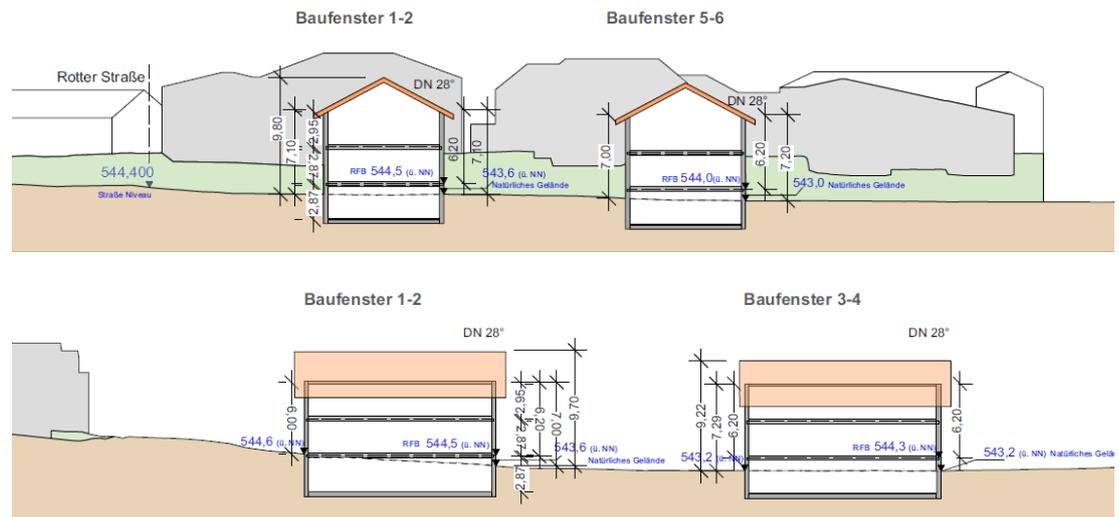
Schemaschnitte mit Höhenlage der Straße, ohne Maßstab
